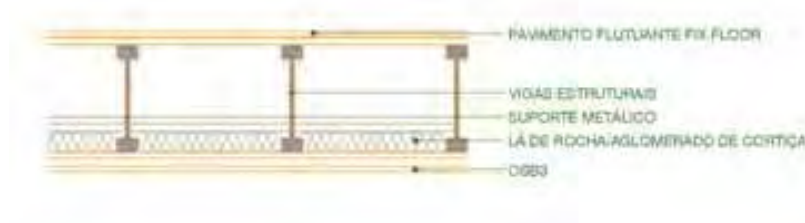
Corte da laje de pavimento, soluções A, B e B2
